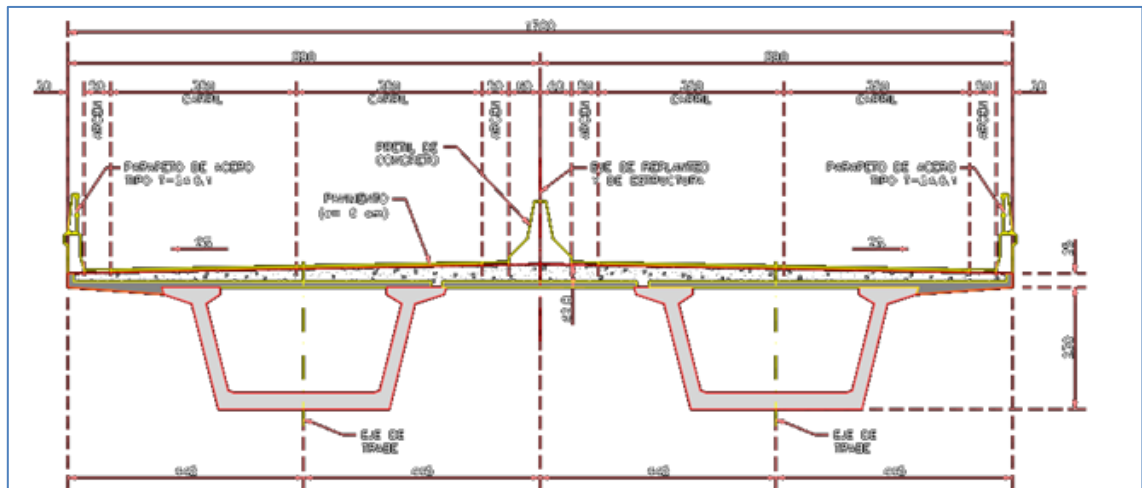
Sección de 17.8 m de ancho con 2 vigas de 2.3 m de canto.
